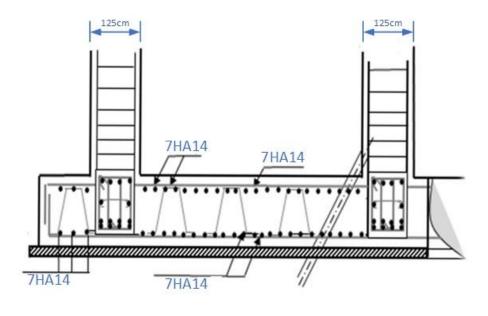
Ferraillage en travée et sur appuis de nervure
